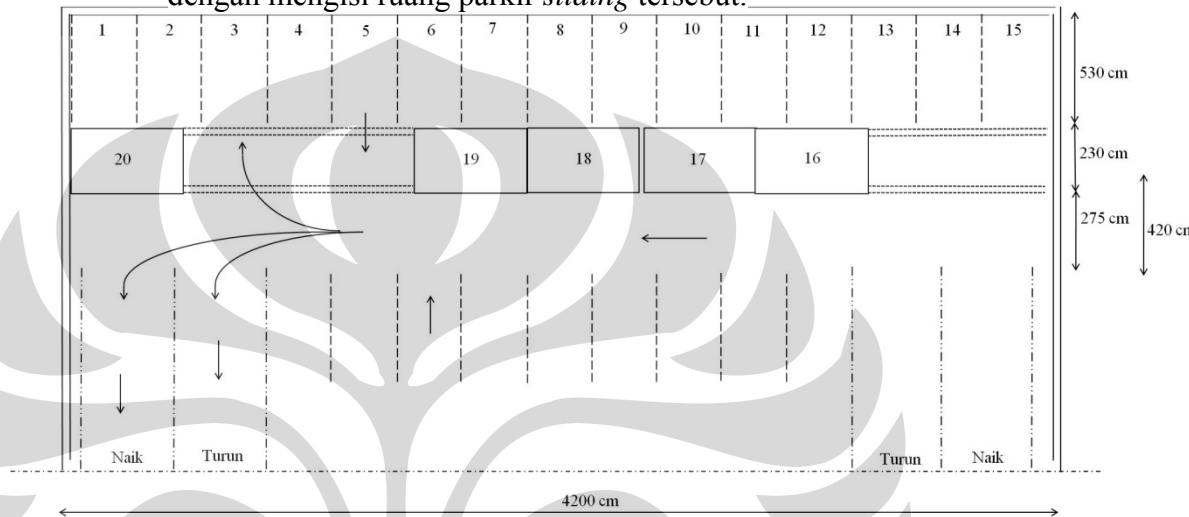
Detail sistem parkir *sliding platform longitudinal
